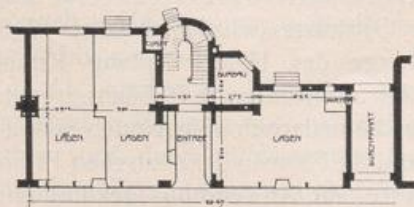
Blumenstrasse 7. Erdgeschoss.
